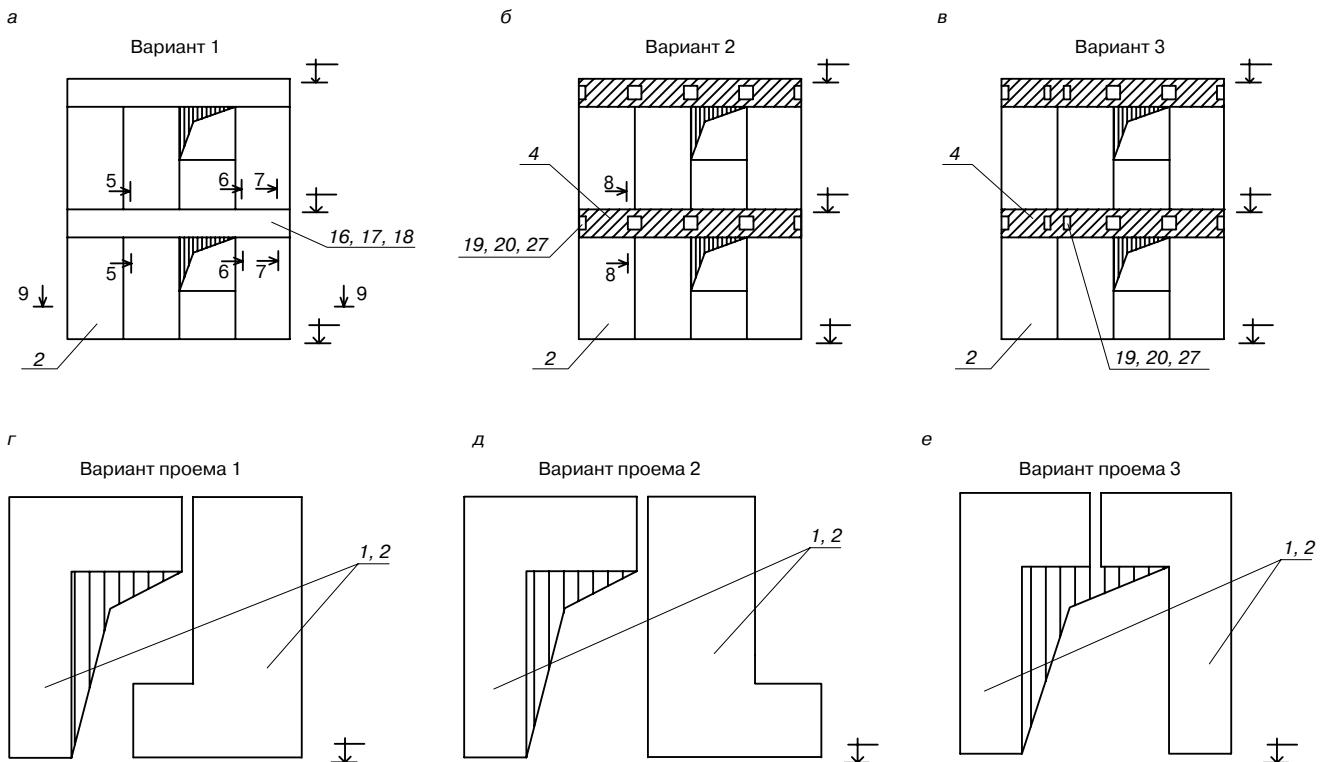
Варианты двухрядной разрезки наружной стены и варианты образования проемов
